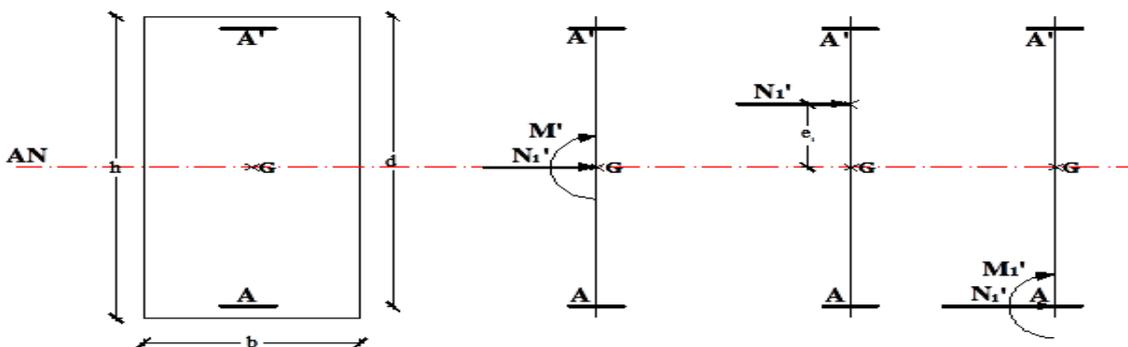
Position de N_1' , M_1' et M_1 sur la section transversale
